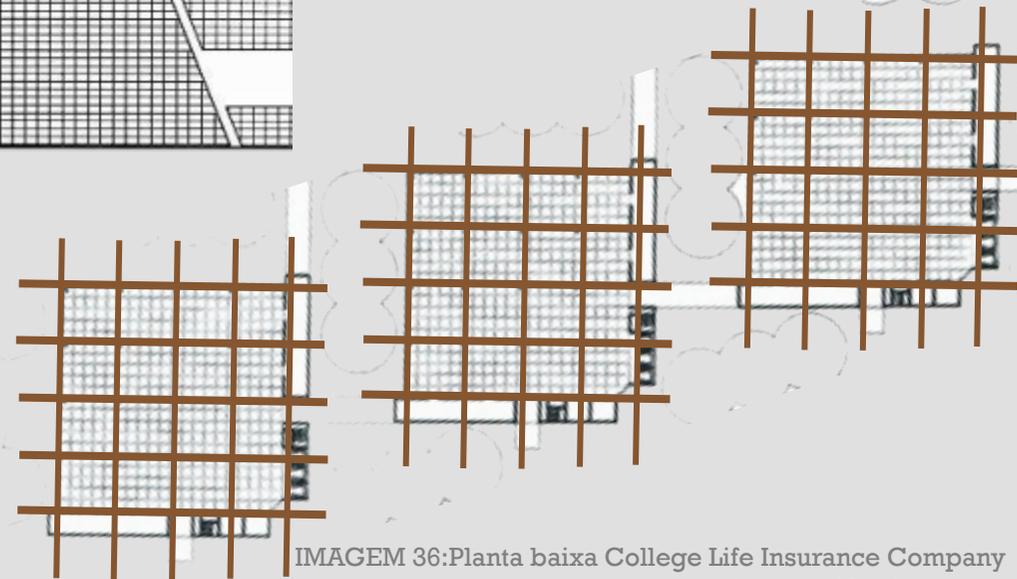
Planta baixa College Life Insurance Company of America Headquarters
